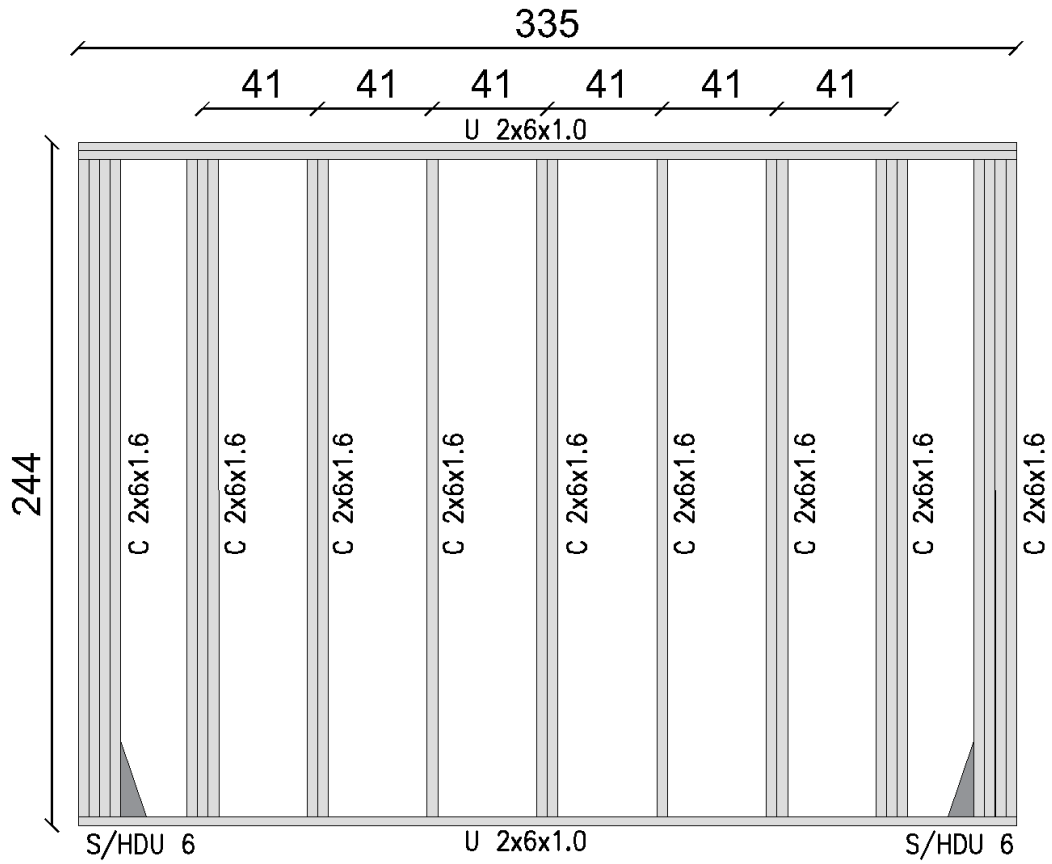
Detalle muro M1, primer piso (medidas en centímetros).
